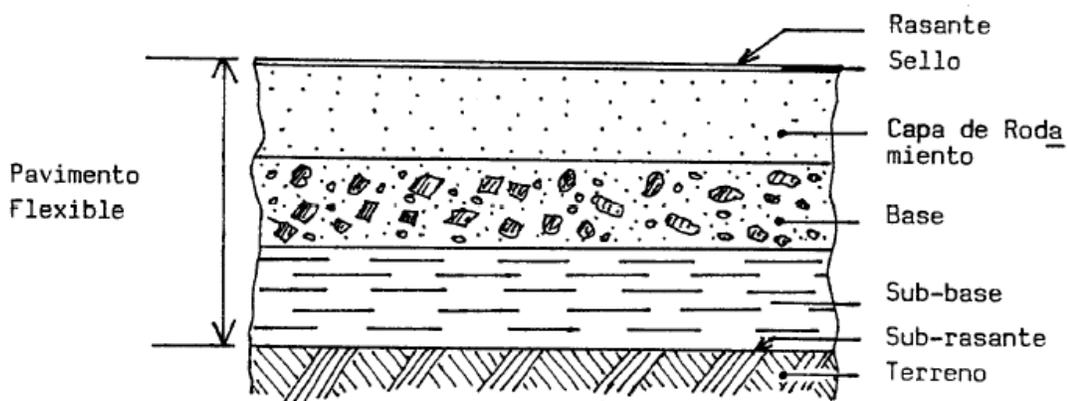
Esquema básico de la estructura de un pavimento flexible.
